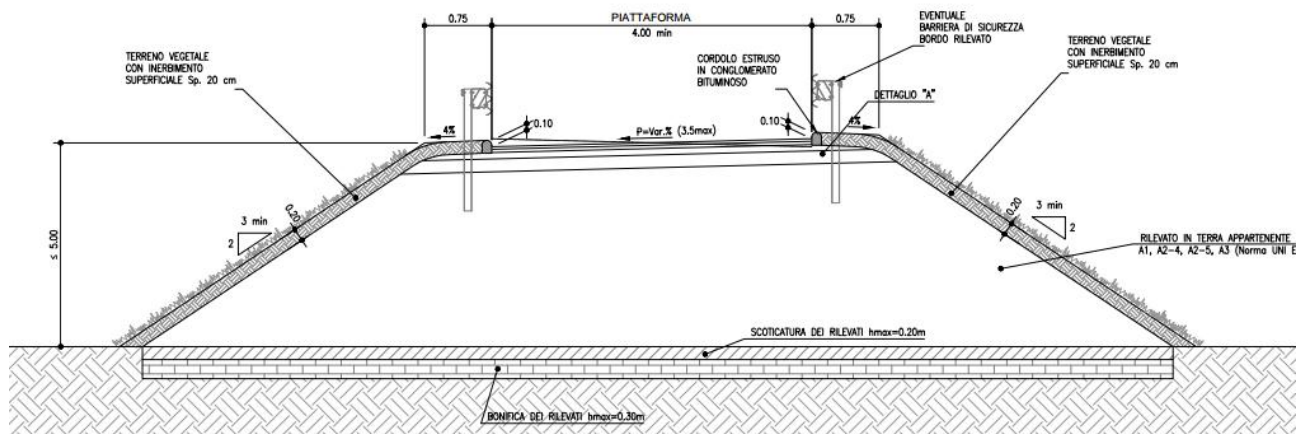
Sezione tipo in rilevato viabilità IN005
